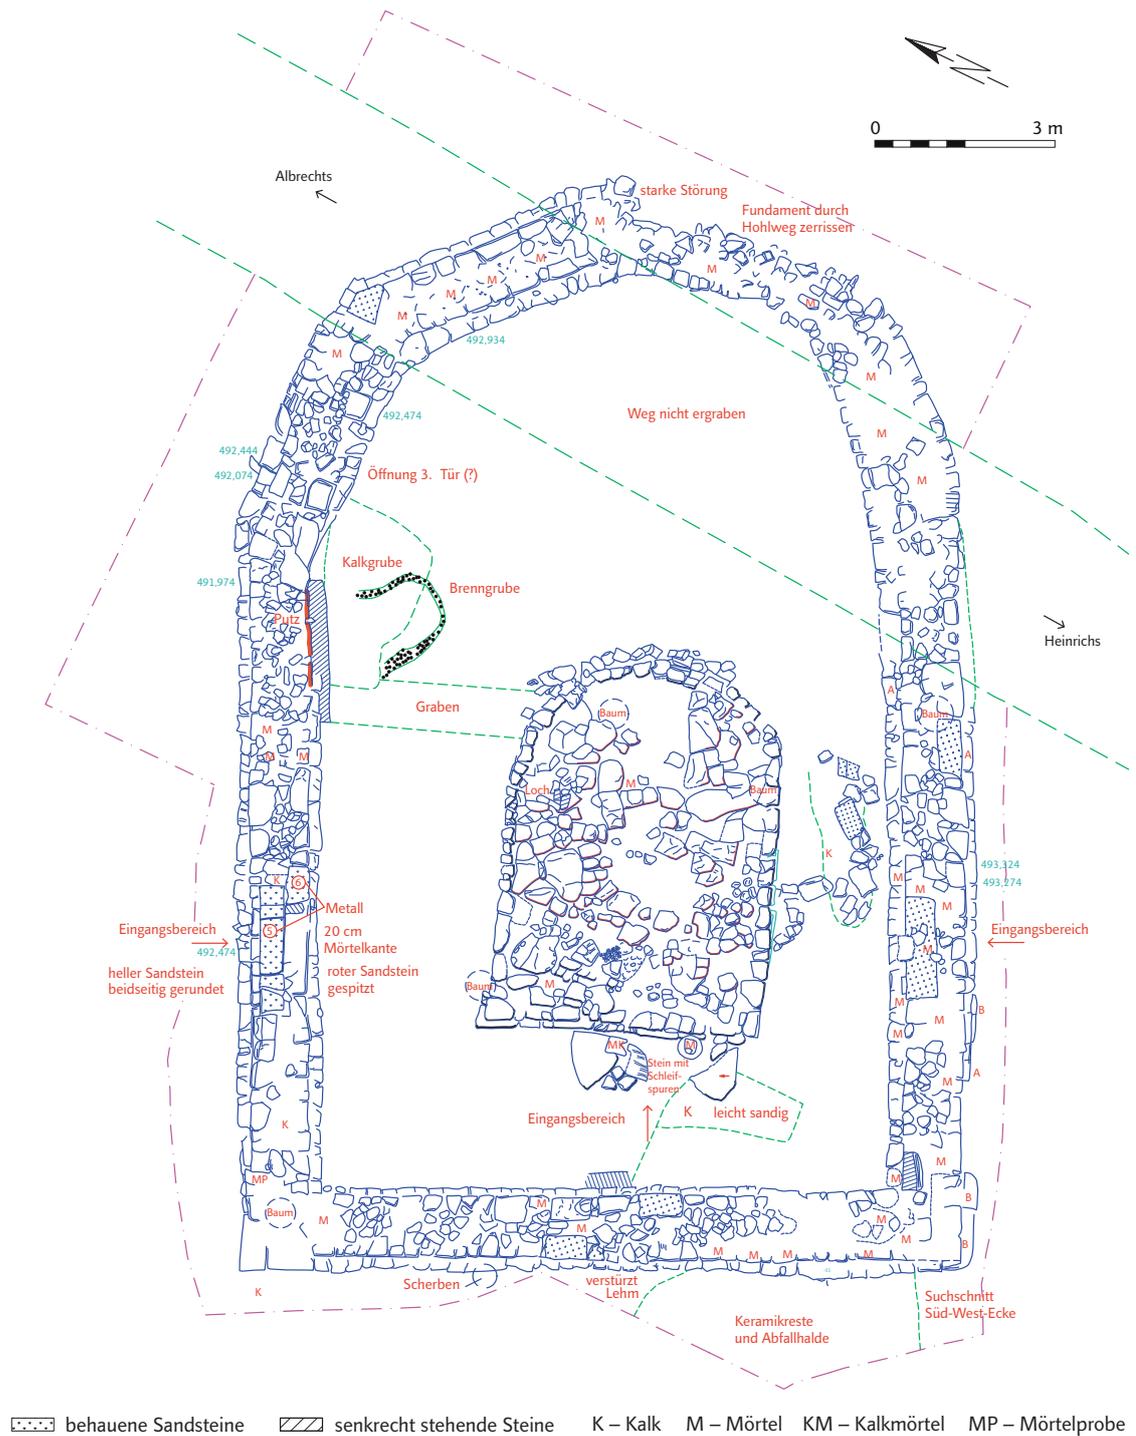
Suhl-Albrechts, Grundriss der Chorkirche und des Bethauses
